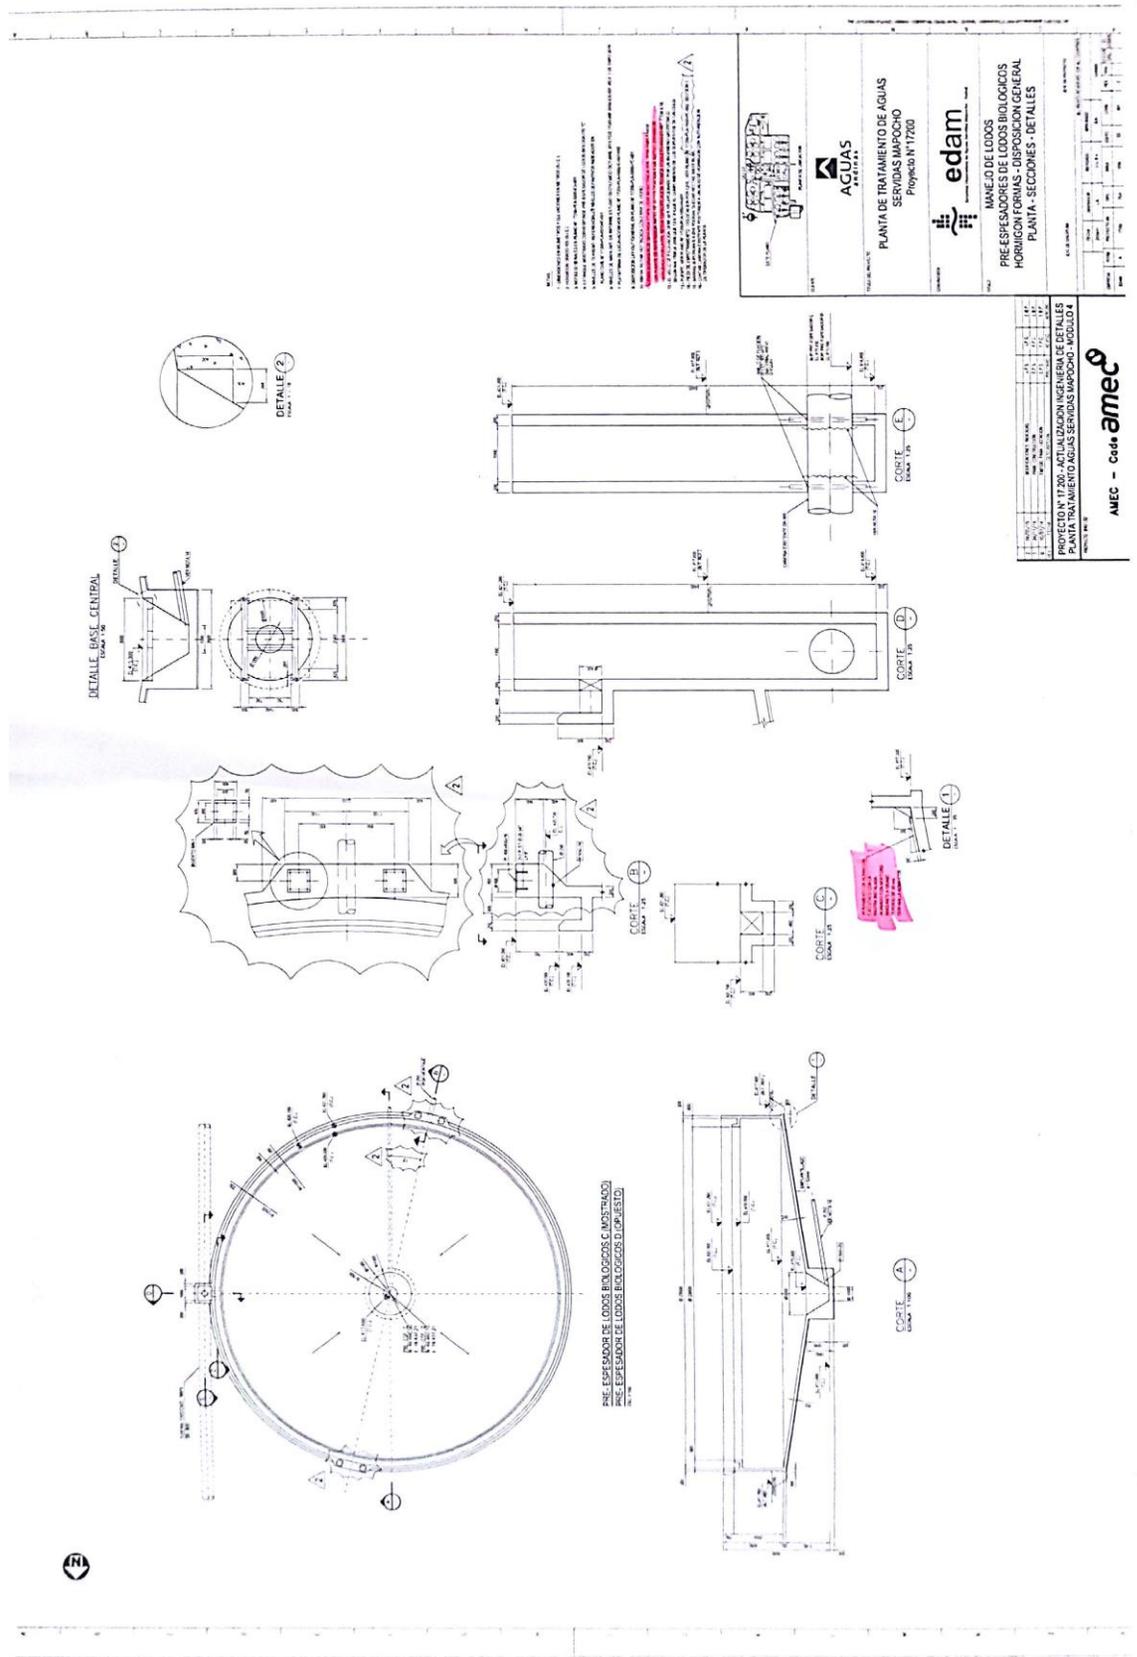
Plano pre-espesadores de lodos. Disposición general.(fuente: escáner de plano)
